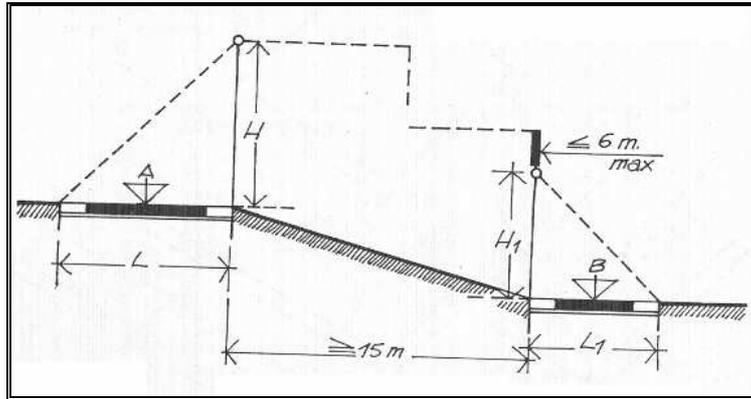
Hauteur des constructions. Construction sur deux voies ($L \neq L_1$) ou sur un dénivellement du terrain et ayant une profondeur de quinze mètres maximum.
